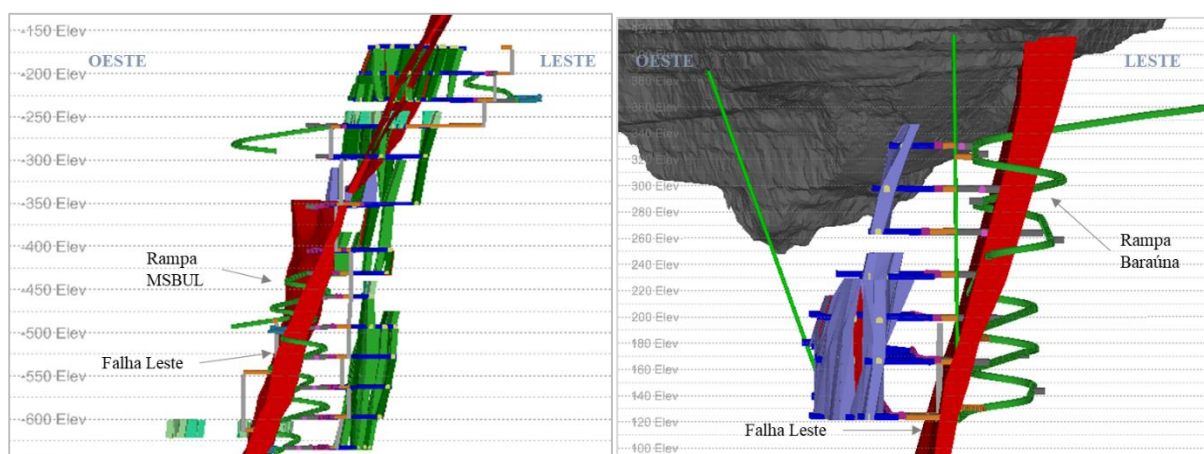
Posicionamento das rampas dos projetos MSBSUL e Baraúna no Q3 - 2020. A atualização da falha principal leste possibilitou a alteração do posicionamento da rampa.
